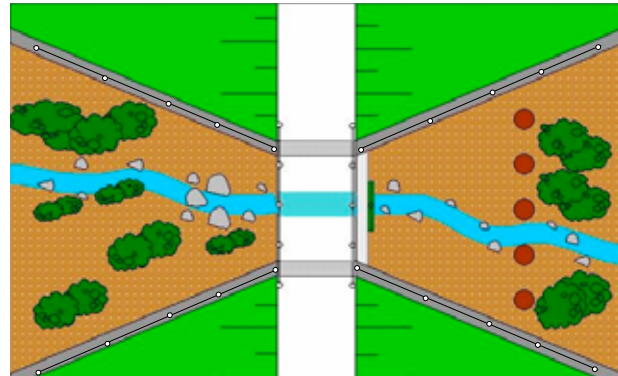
Draufsicht auf einen Damm mit offener Bauweise
